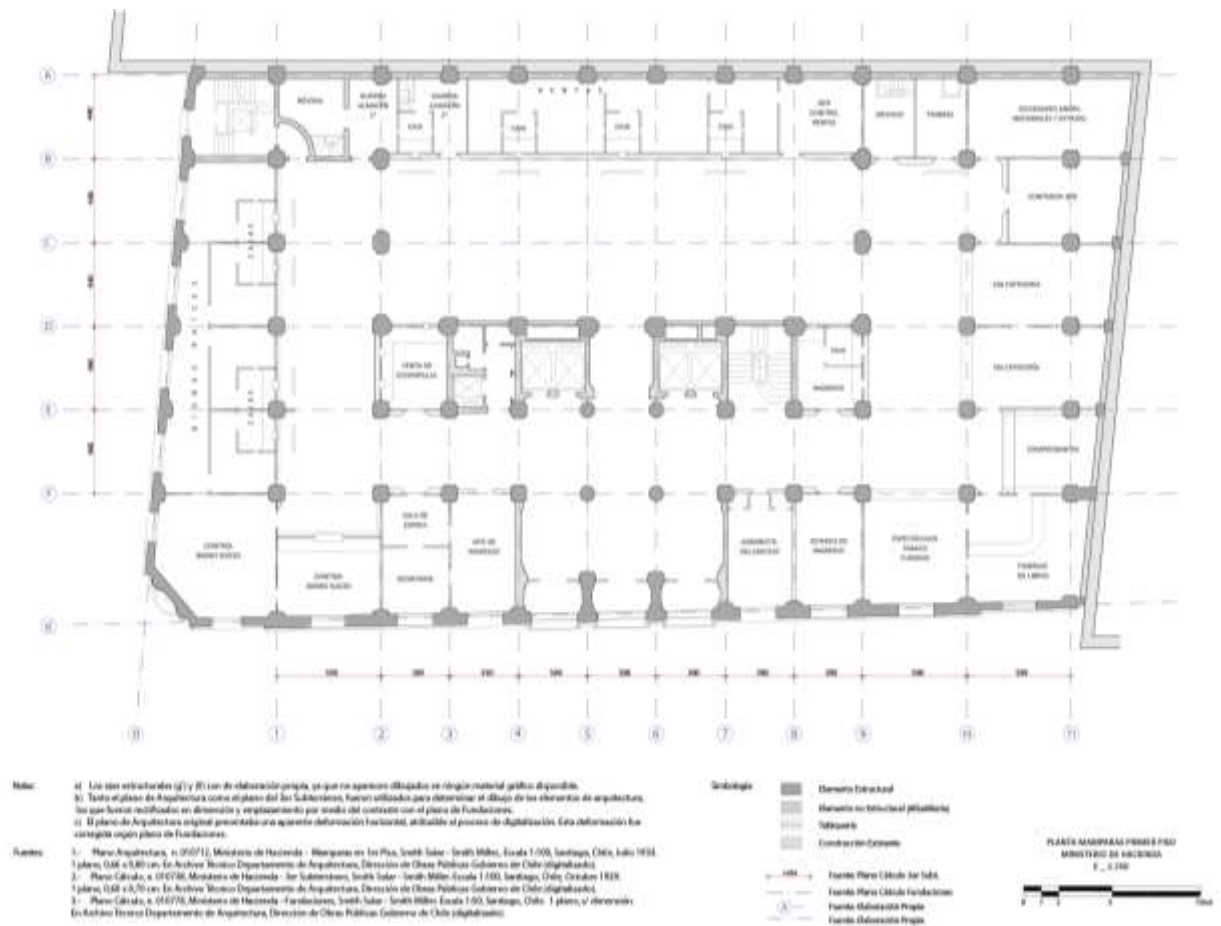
Planta Primer Nivel Ministerio de Hacienda, Smith Solar & Smith Miller Arquitectos. Redibujado a partir del plano original contenido en el Ministerio de Obras Públicas. Archivo Digital Ministerio Obras Públicas.
